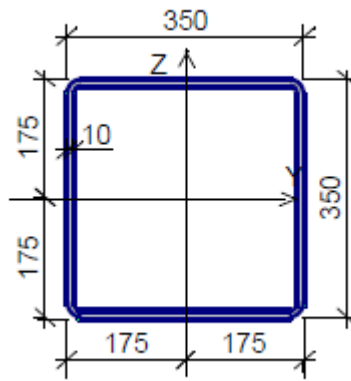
Сечение верхнего и нижнего пояса фермы
